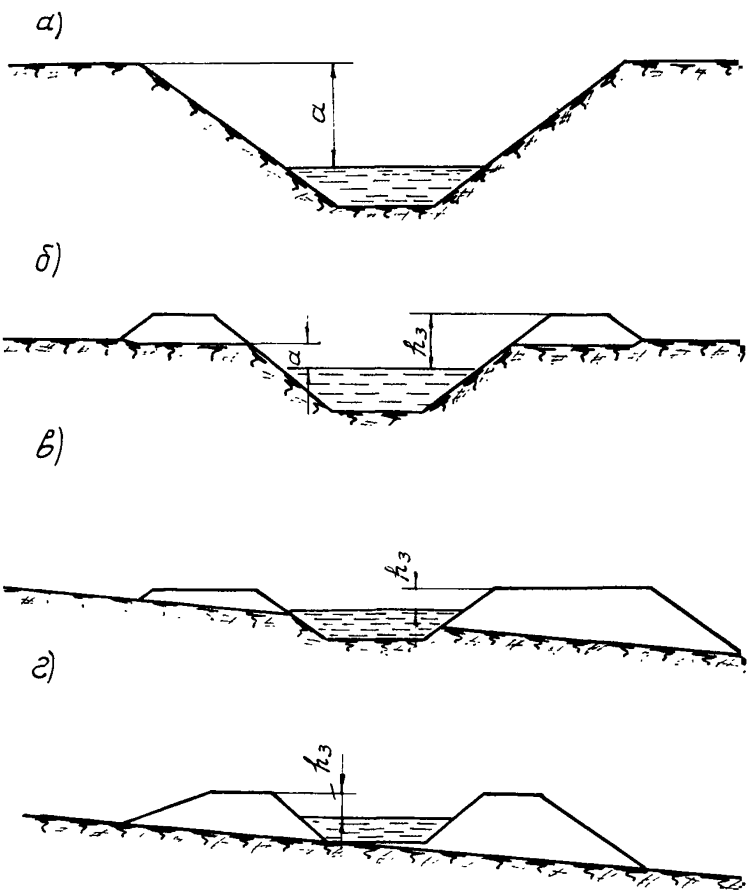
Рис. I. Поперечные сечения каналов на лессовых просадочных грунтах:
